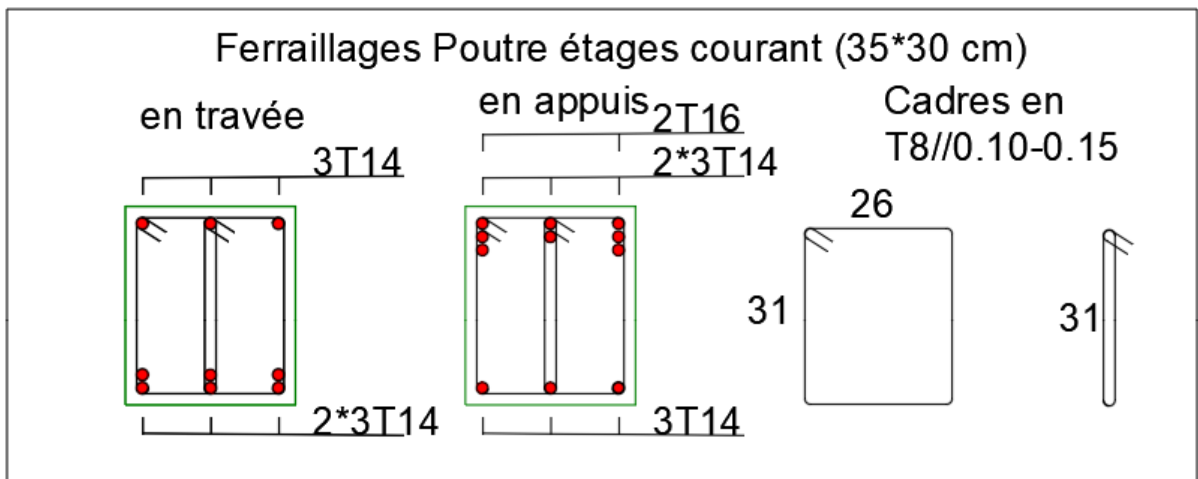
Ferraillages Poutre étages courant 35\*30 cm.
